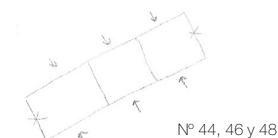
Bocetos en planta de la disposición de las construcciones situadas en la Rúa Bueu-Coia, nº 44, 46 y 48 (autoría propia).
